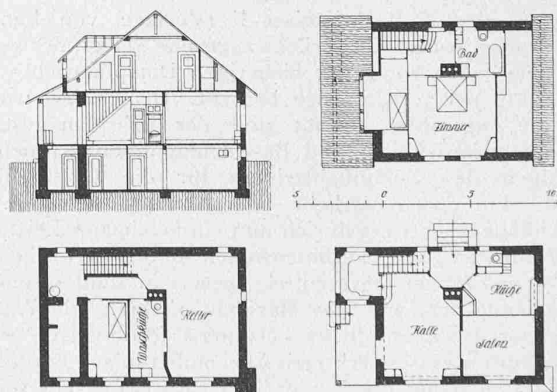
Landhaus Debeuf. — Grundrisse und Schnitt 1 : 400.
